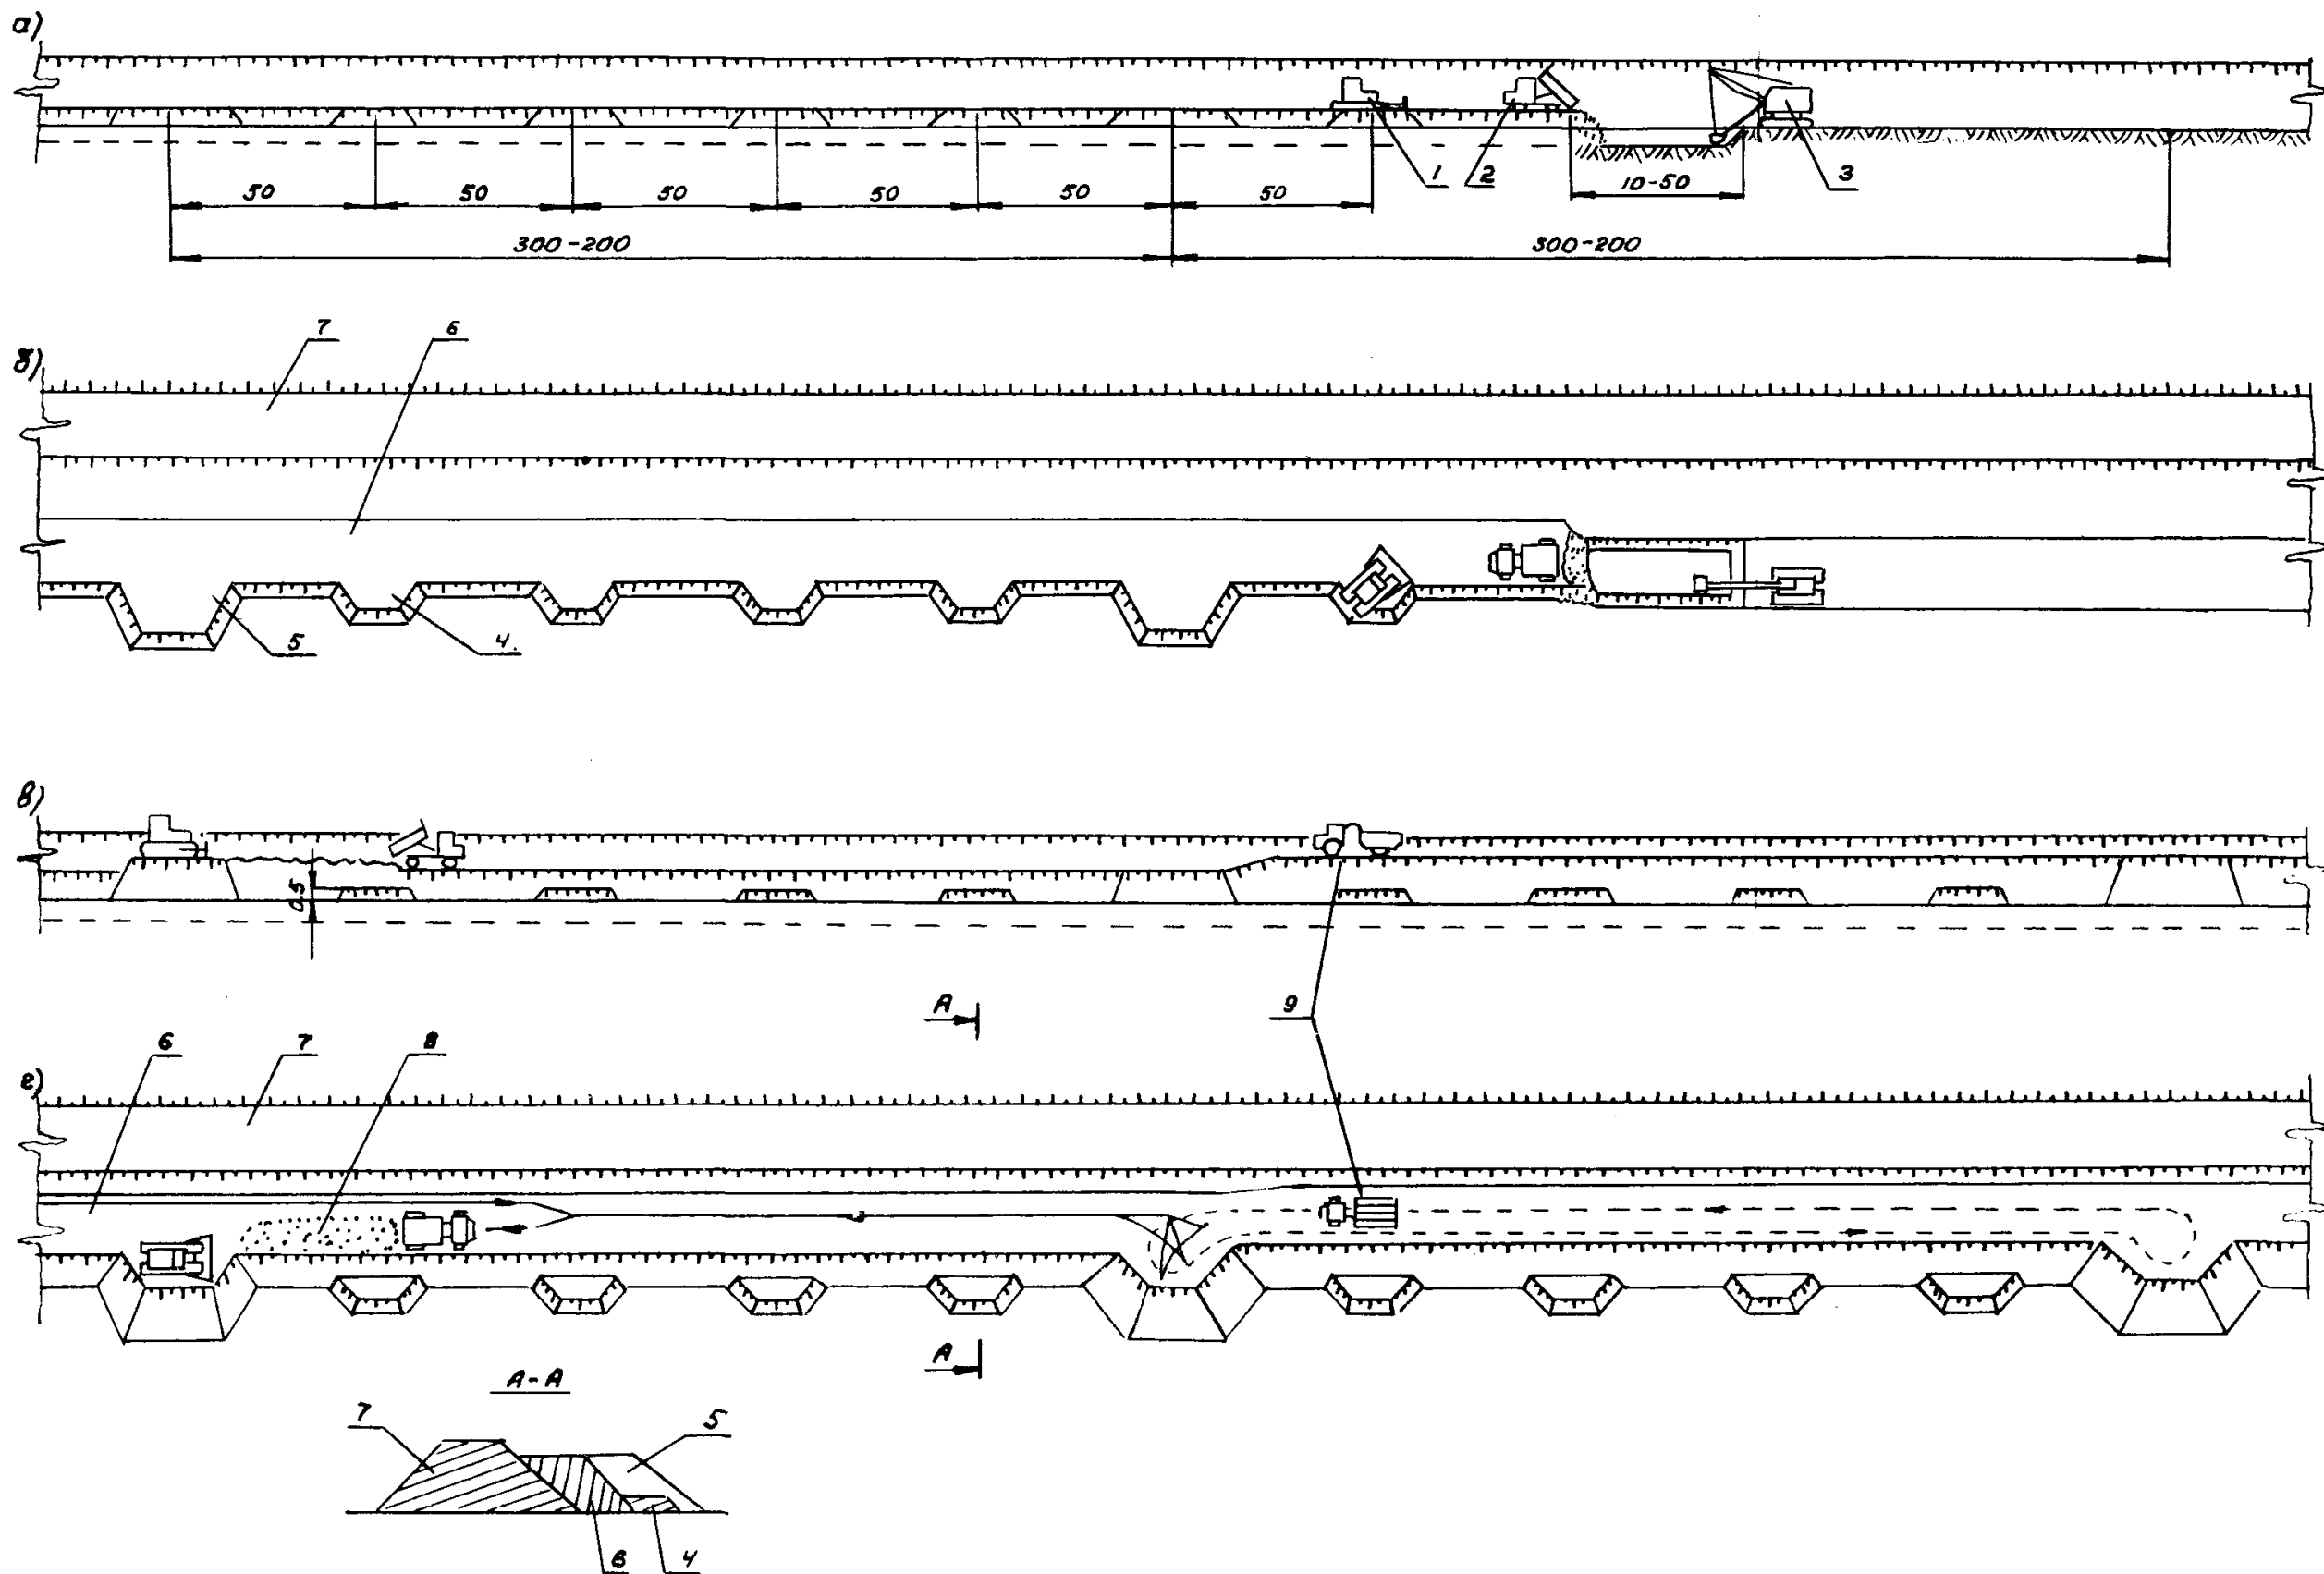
Отсыпка насыпи на болоте по схеме двухполосного ведения работ:
